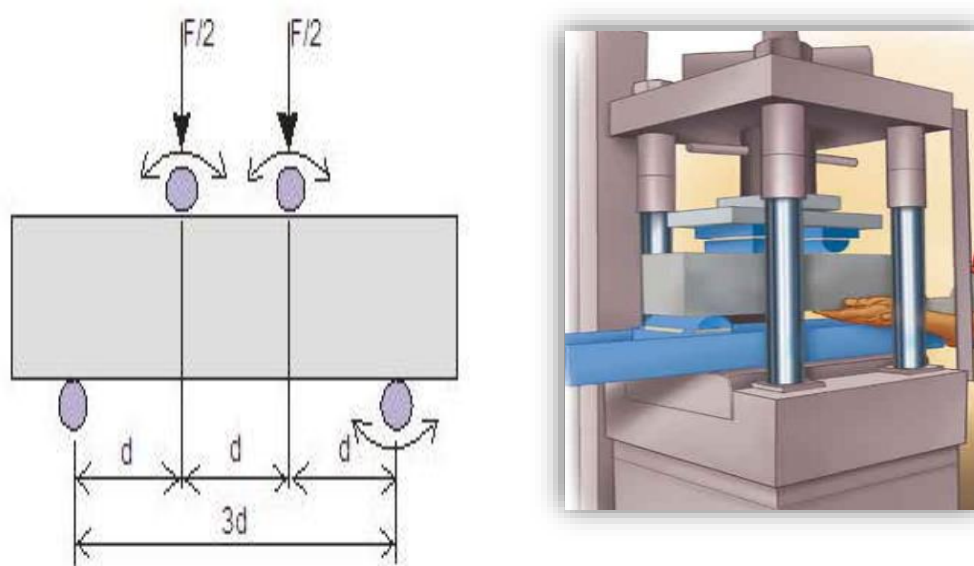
Ensayo a flexión de viga simplemente apoyada.
